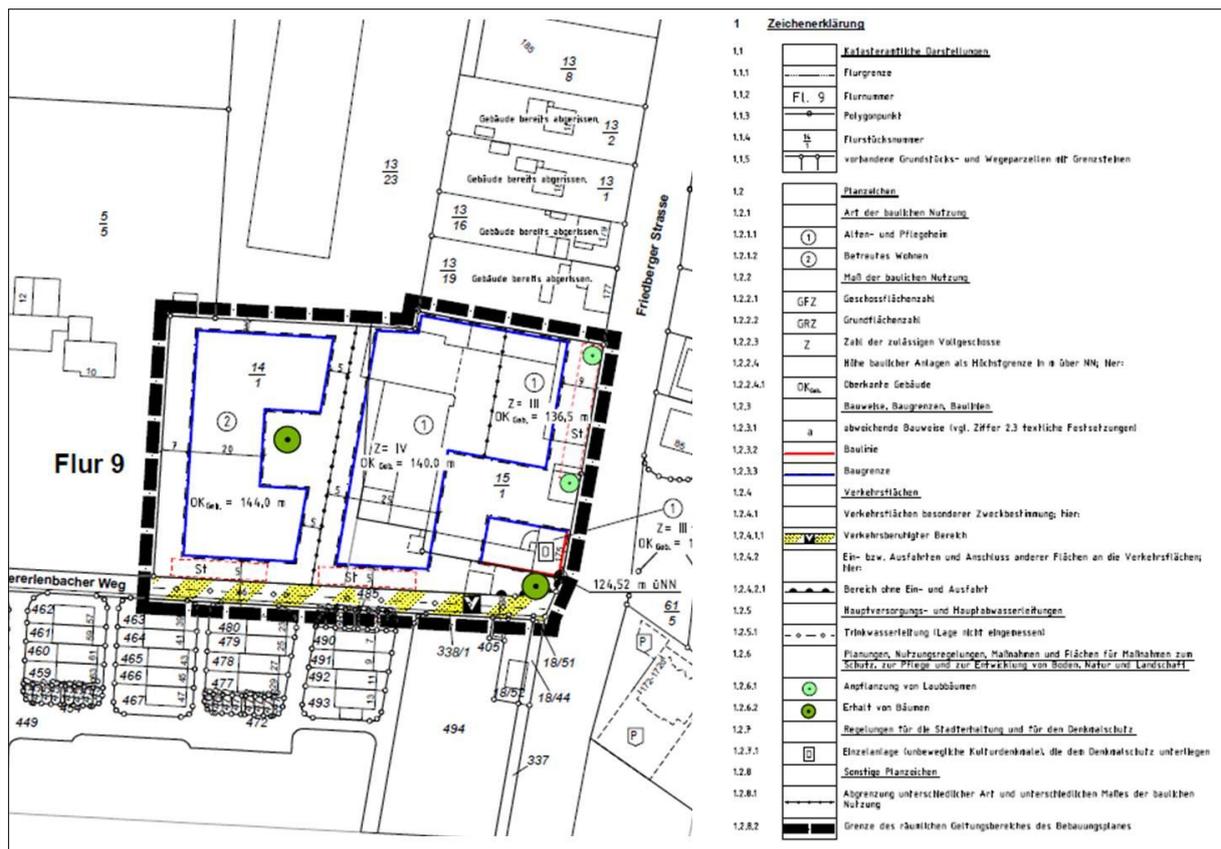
Geplante Bebauung des Planungsraums in Bad Vilbel – Dortelweil, Entwurf (Quelle: Planungsbüro Fischer).
